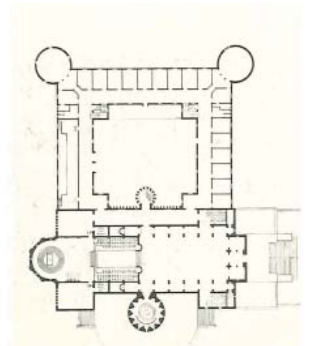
Pianta progetto originario dell'abbazia di Vaals
